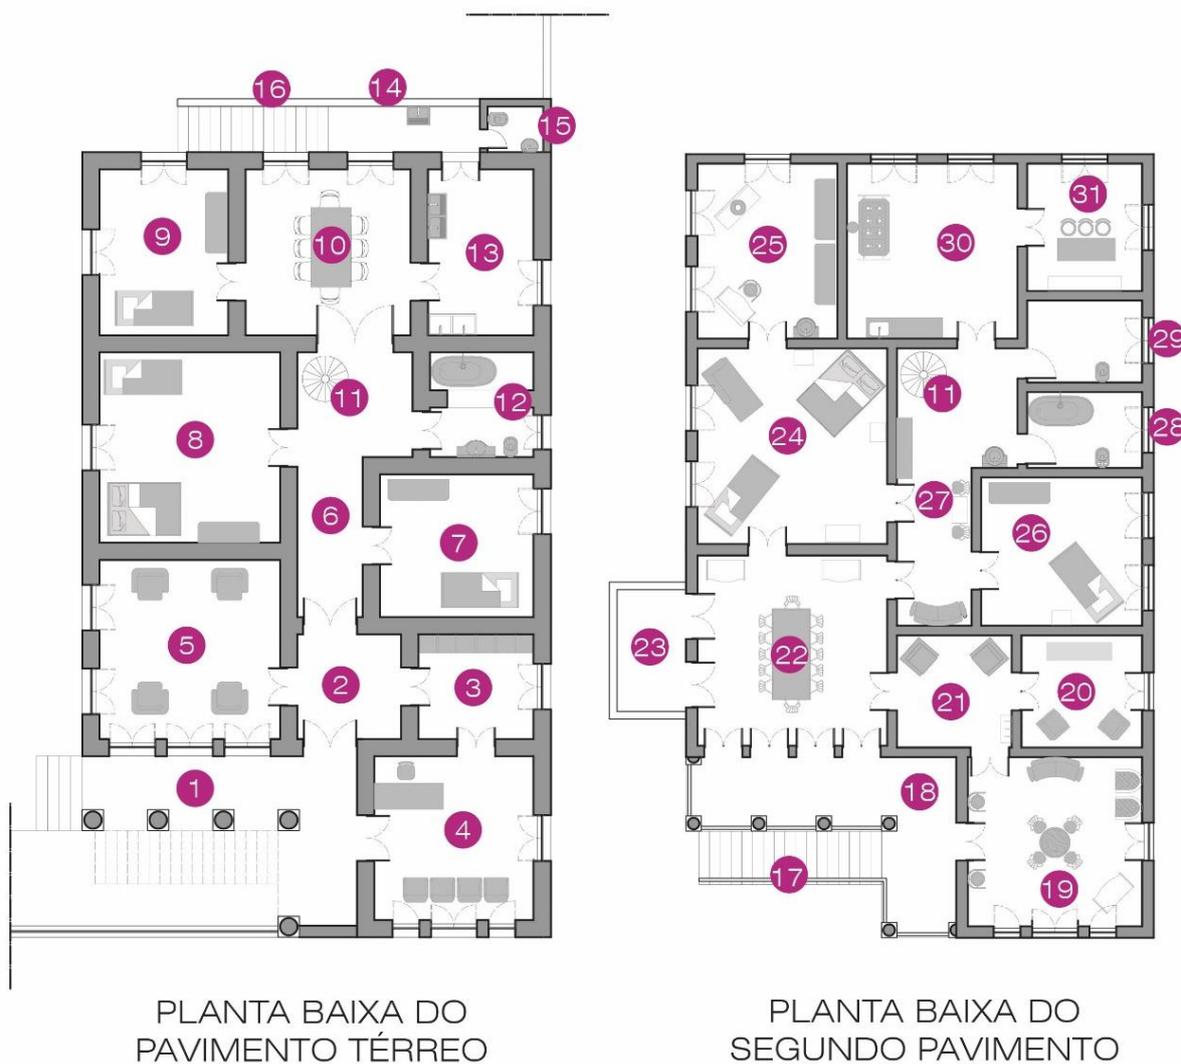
Planta baixa dos dois pavimentos do Solar dos Bias Fortes.
